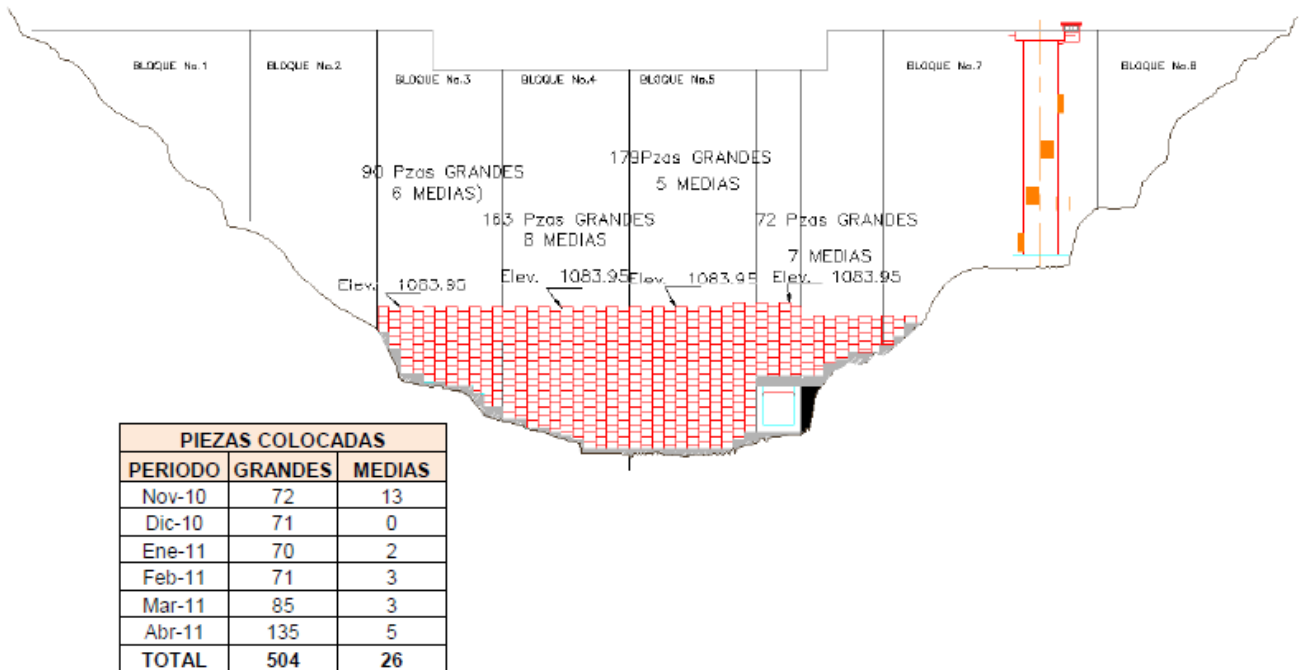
COLOCACION DE PANELES PREFABRICADOS
